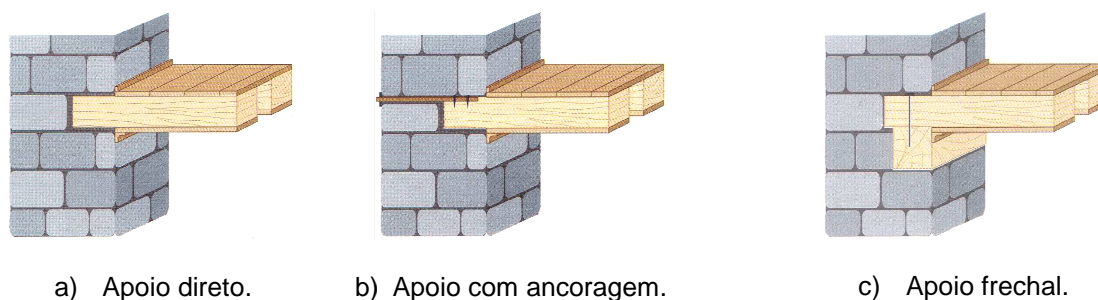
Ligações entre pavimentos e respetivas paredes de apoio (Appleton, 2003).
